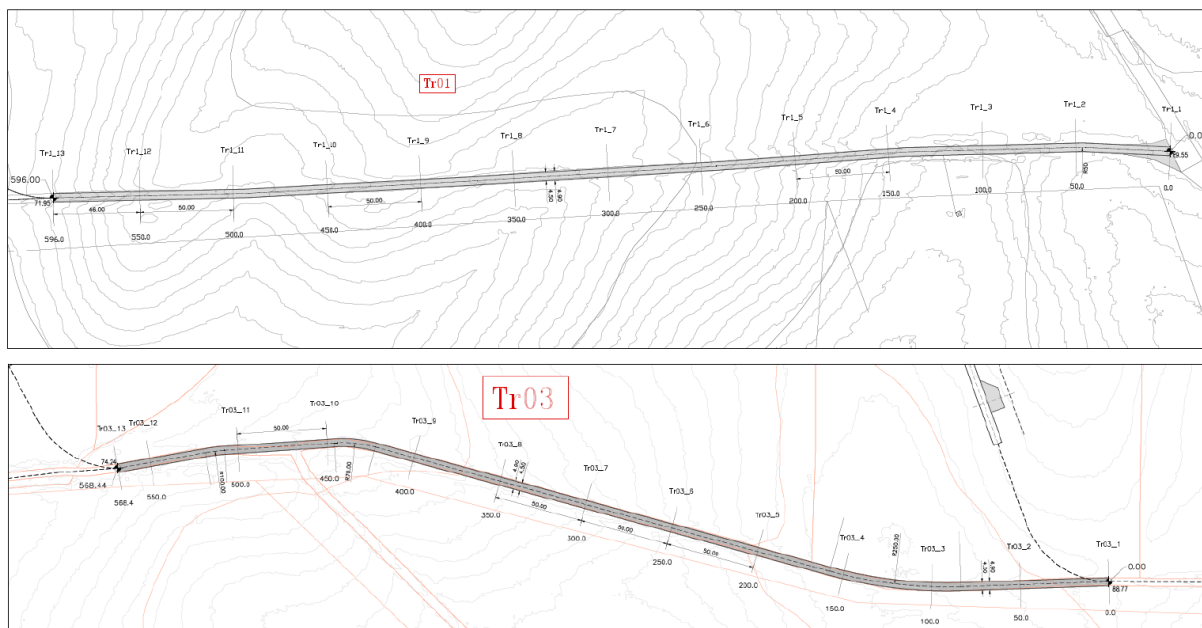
Stralcio planimetrico degli adeguamenti della Strada Ponte dell'Abbadia in progetto – Tratti Tr01 e Tr03
